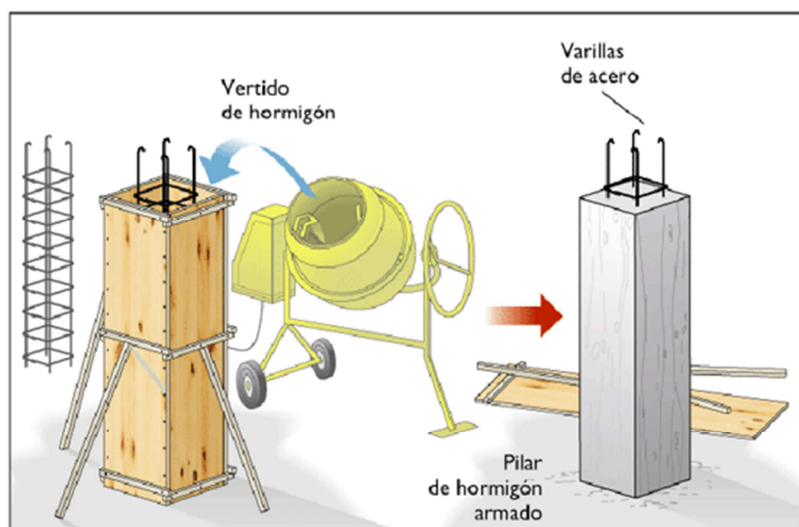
Hormigón Armado como elemento estructural en construcciones
